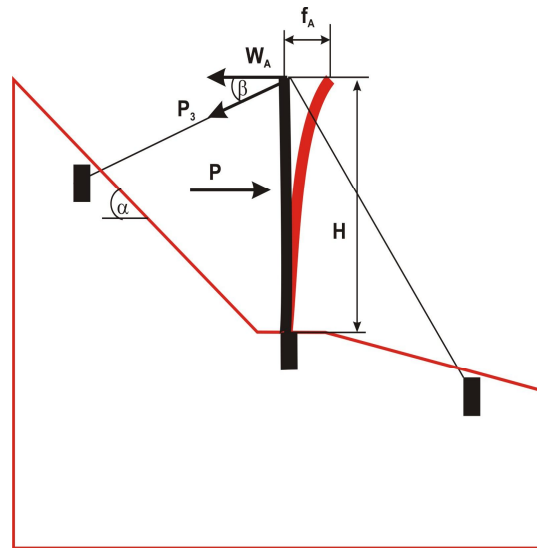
Схема для определения усилий в верхних по откосу или склону поперечных растяжках.
